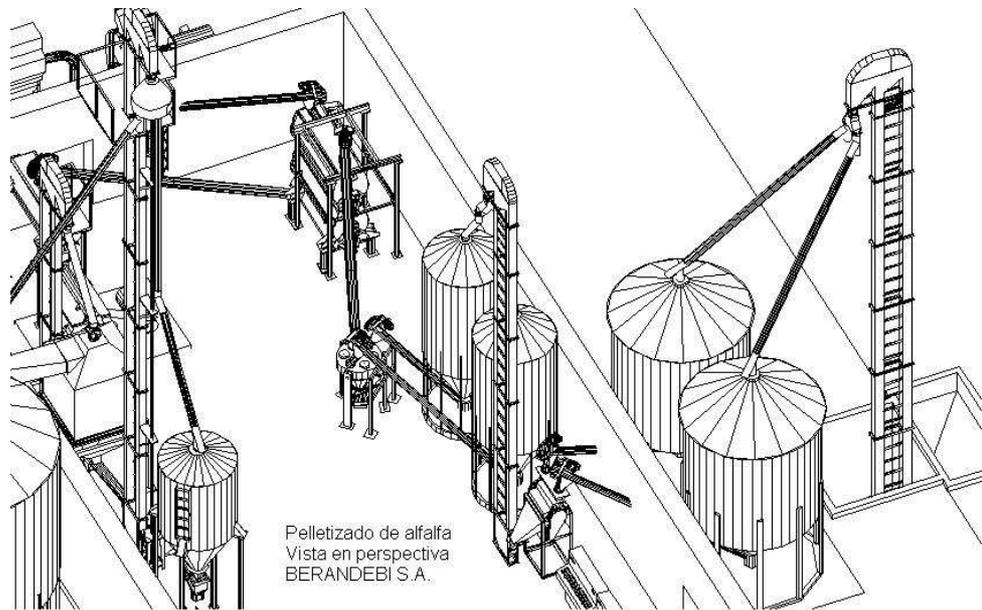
Planta de procesamiento de alfalfa (corte). Fuente: Barandebi (2010).
